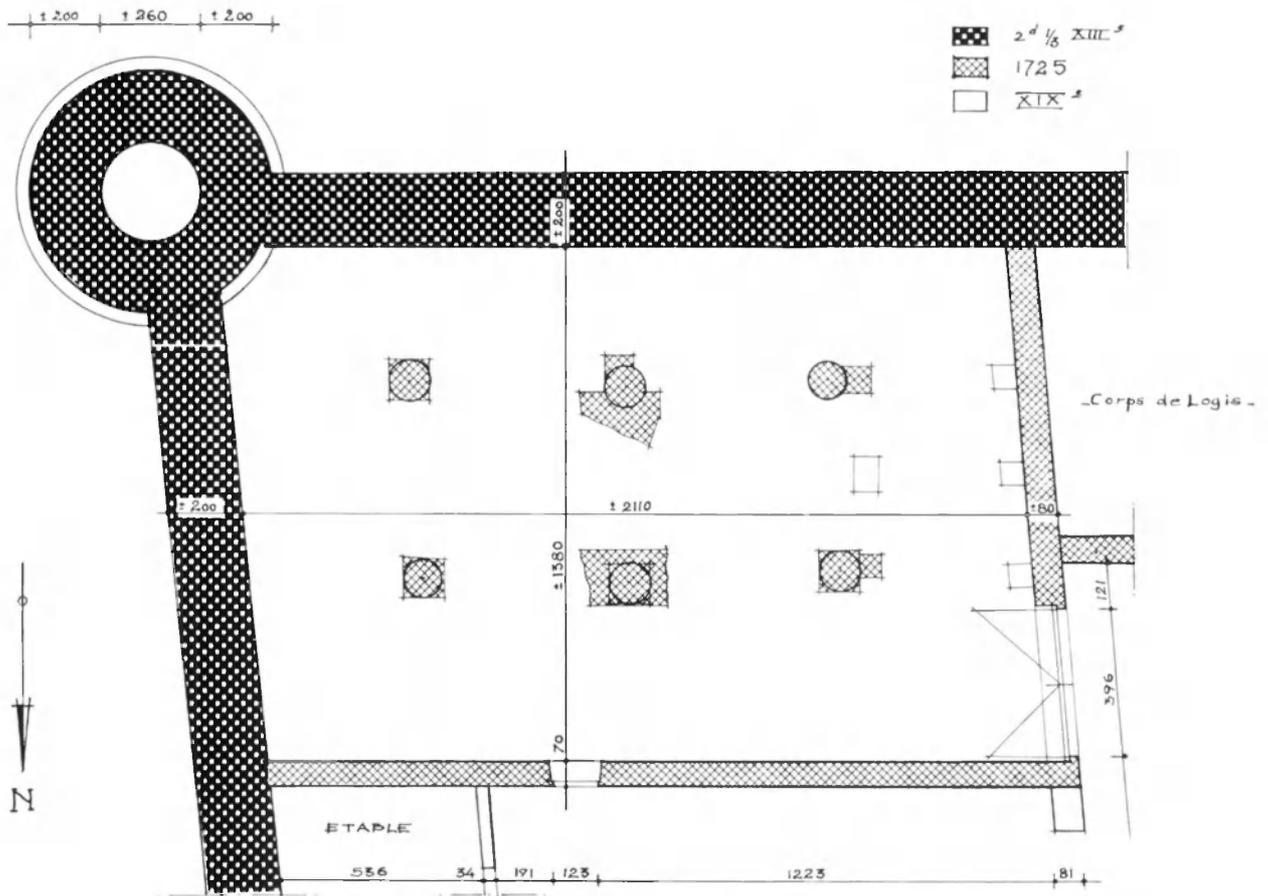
Opprebaix. Plan terrier de la grange, Echelle 1:200.
